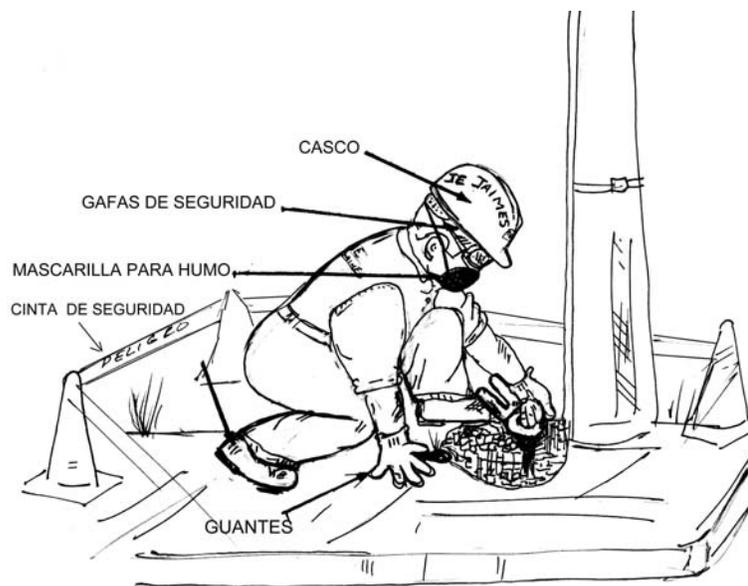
Equipo de protección personal para aplicación de la soldadura exotérmica.
